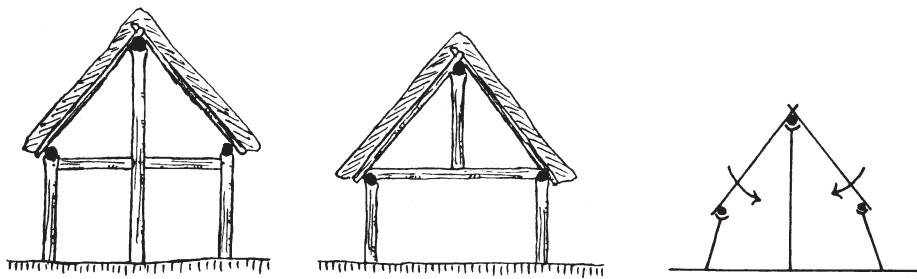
Rofendach mit Firstsäule, Rofendach mit abgefangener Firstsäule, Schubwirkung des Rofendaches (nach BAUMGARTEN 1985, 21, Abb. 6a, c, d).
